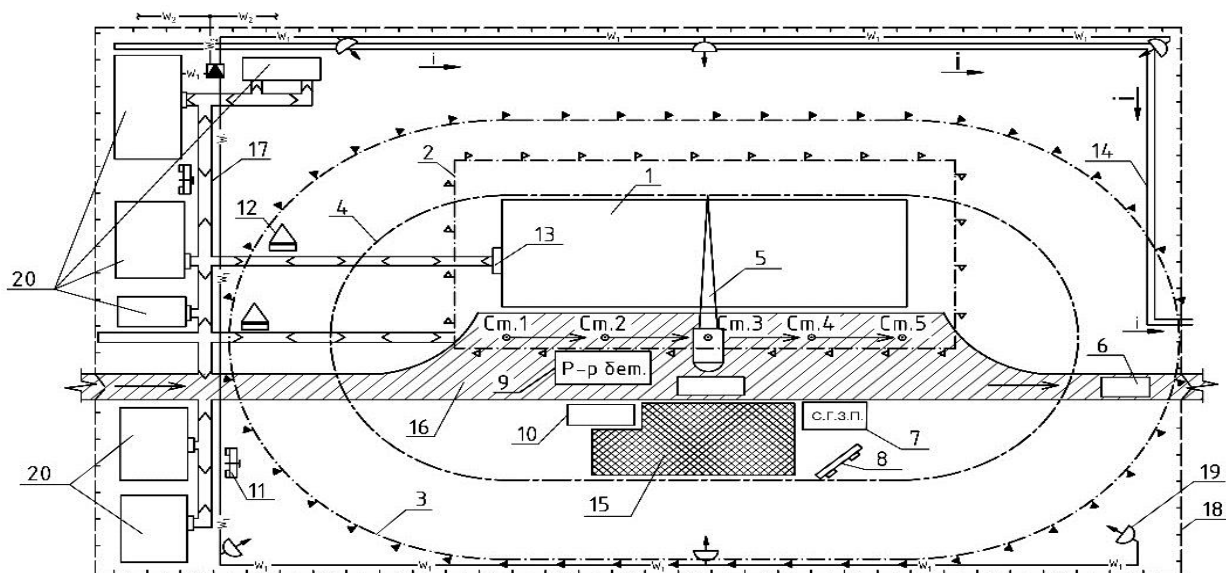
Объектный строительный план на возведение надземной части здания: 1 – возводимое здание; 2 – граница опасной зоны вблизи строящегося здания; 3 – граница опасной зоны обслуживания краном (для всех стоянок крана); 4 – рабочая зона крана; 5 – самоходный кран; 6 – зона мойки автомобилей; 7 – площадка для грузозахватных приспособлений и тары; 8 – стенд со схемами строповки и таблицами масс грузов; 9 – площадка для приема раствора и бетона; 10 – площадка мусорных контейнеров; 11 – стенд с противопожарным инвентарем; 12 – знак и надпись, предупреждающие о работе крана; 13 – навес над входом в здание; 14 – водоотводная канава; 15 – зона складирования конструкций; 16 – временная автомобильная дорога; 17 – пешеходная дорожка; 18 – ограждение строительной площадки; 19 – прожектор; 20 – временные здания
